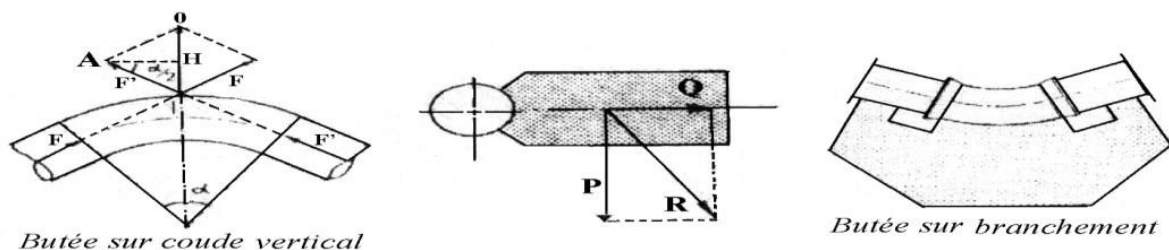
Butée sur coude vertical et butée sur branchement
